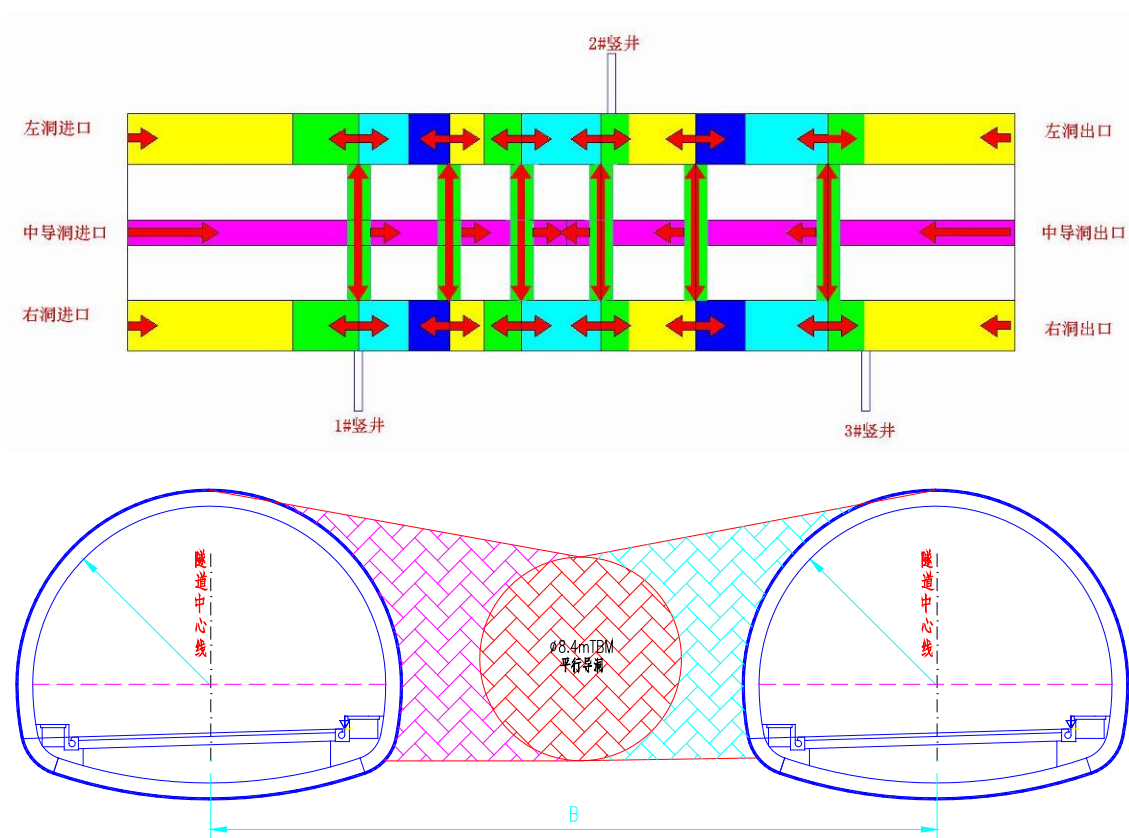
正洞钻爆+中导洞 1TBM+1 竖井钻爆法施工平面、横断面示意图
